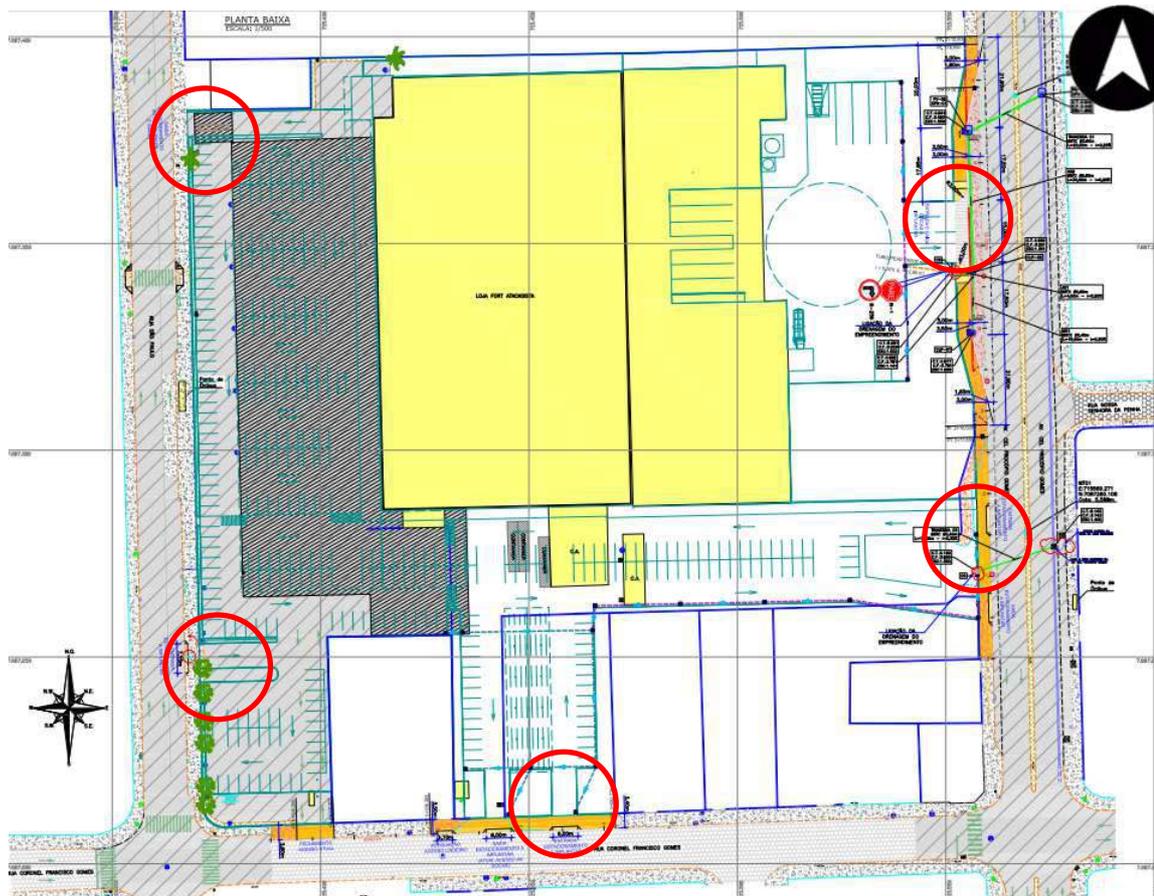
Layout da expansão do empreendimento. Fonte: Autor.
